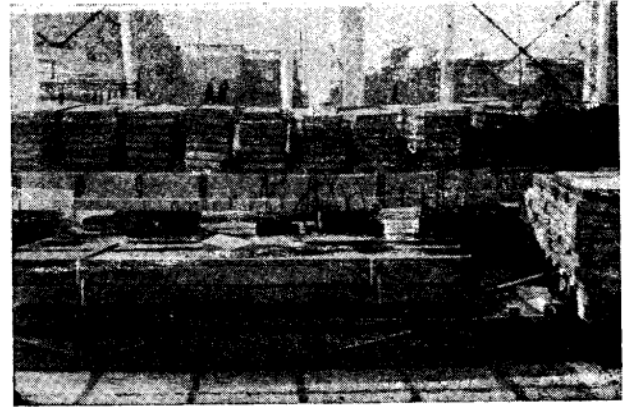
Испытание плит покрытий из аглопоритобетона марки 300 на Гомельском заводе СЖБ № 9
